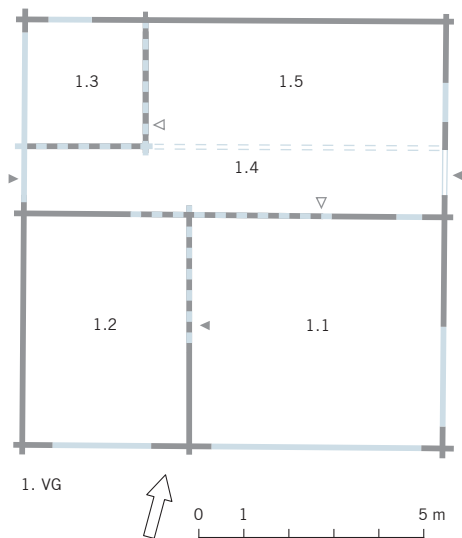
Grubenstrasse 37 in Oberägeri, Grundriss des ersten Vollgeschosses.
